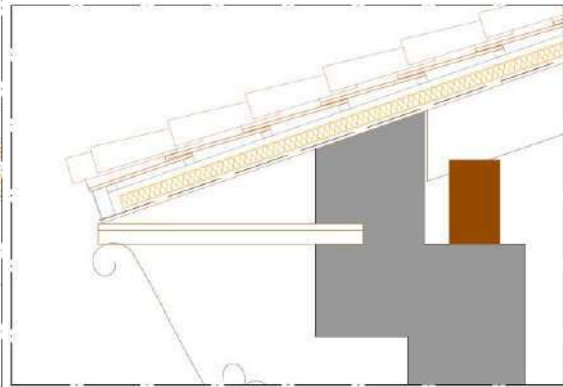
Detalle de propuesta de alero, apoyo en muro perimetral. 2016. Fuente Propia
